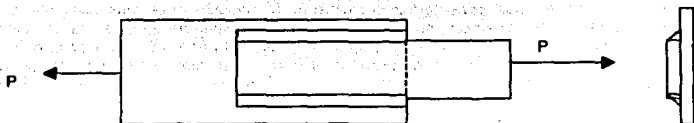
La soldadura de filete es el tipo que se usa más extensamente.
